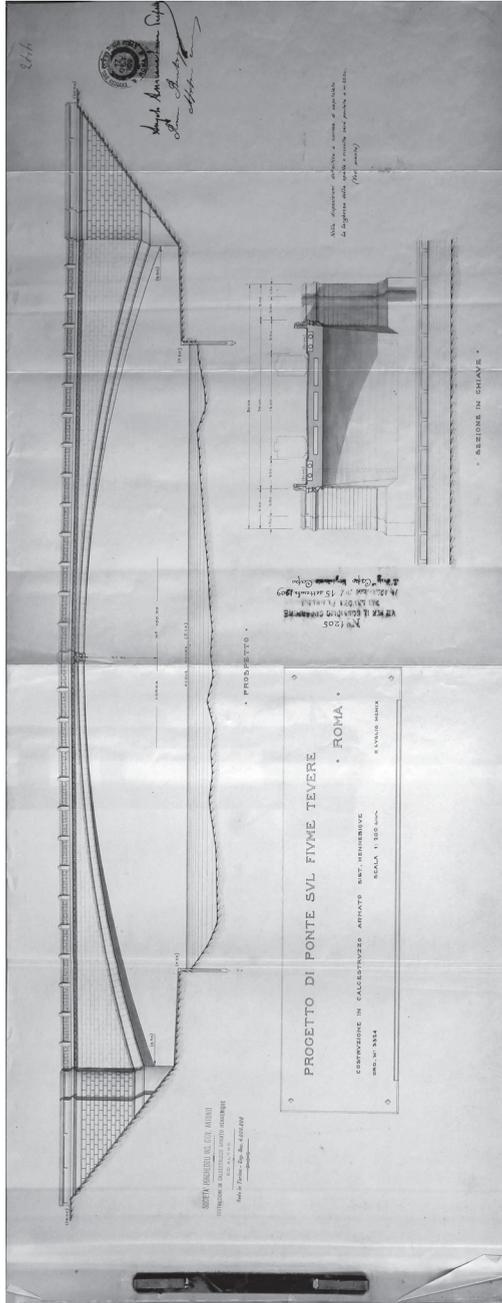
Progetto del ponte del Risorgimento, elaborato dalla Società Porcheddu datato 2 luglio 1909 e allegato al contratto siglato il 2 ottobre 1909: tavola con prospetto e sezione in chiave (ASCapitolino)
